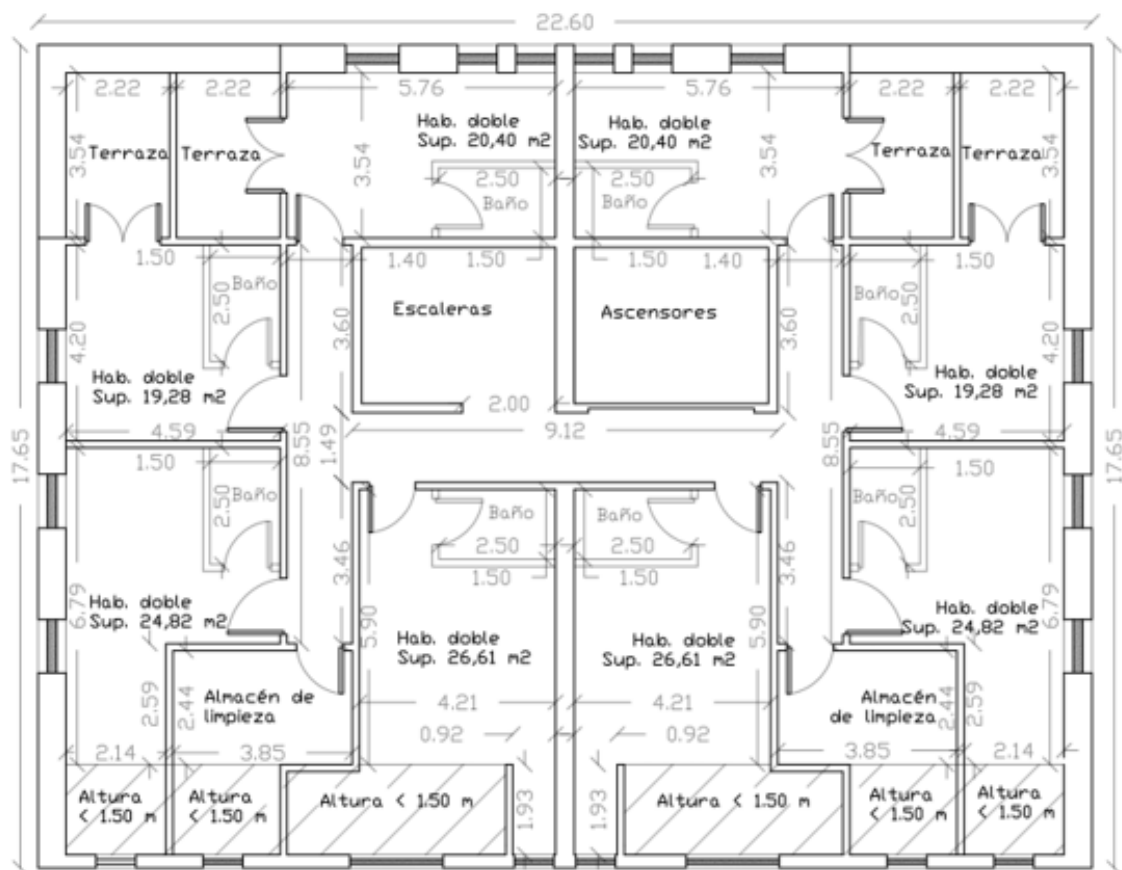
Extracto de la segunda planta redistribuida. Fuente: Elaboración propia
